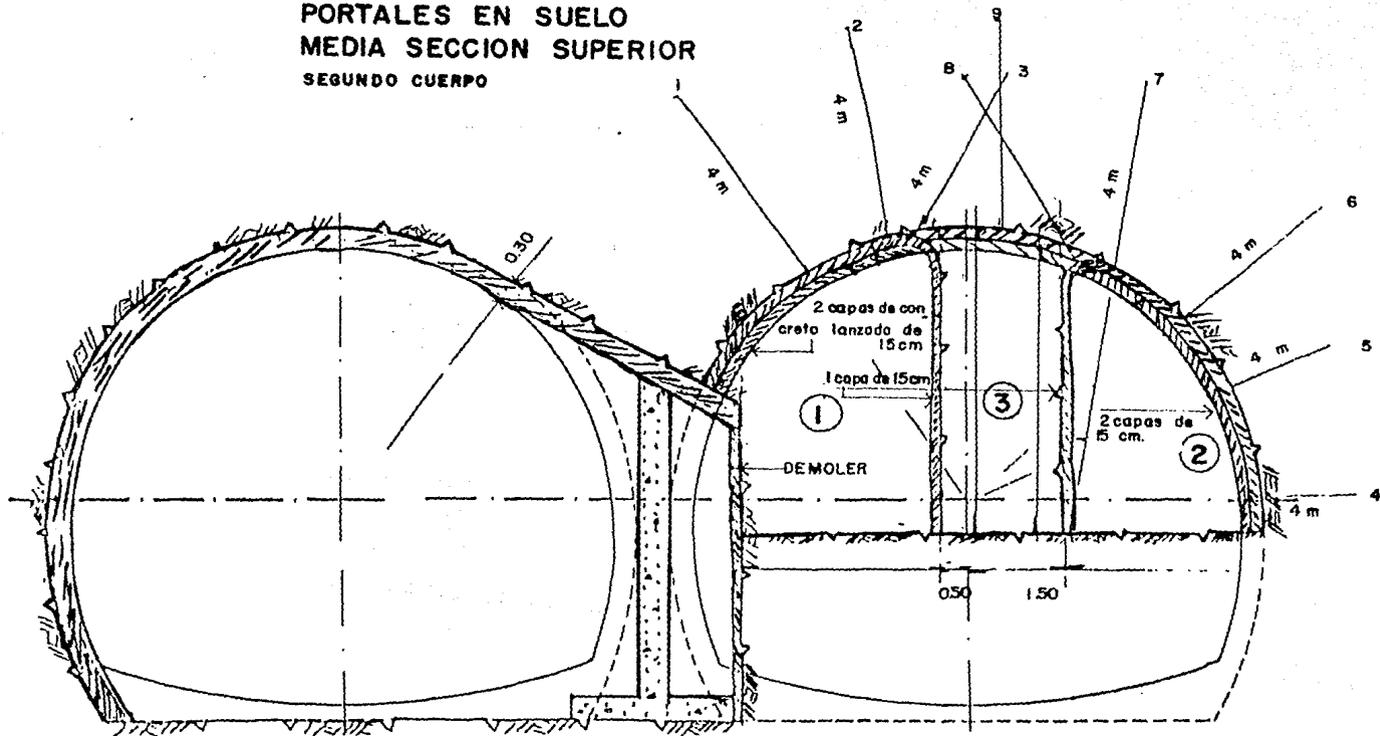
CONSTRUCCION MURO CENTRAL
